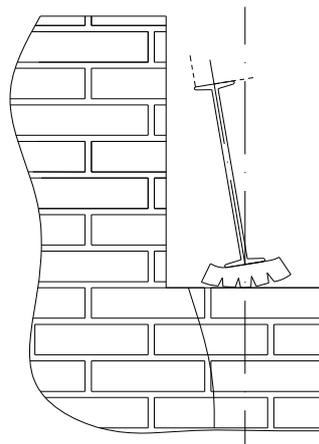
Повреждение кирпичной пилястры при местной перегрузке из-за разрушения неармированной бетонной подушки
